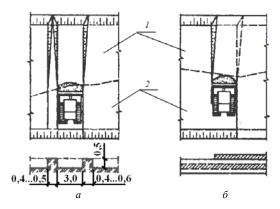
Схемы резания и перемещения грунта бульдозером: a — траншейный; δ — послойный; I — насыпь; 2 — выемка
